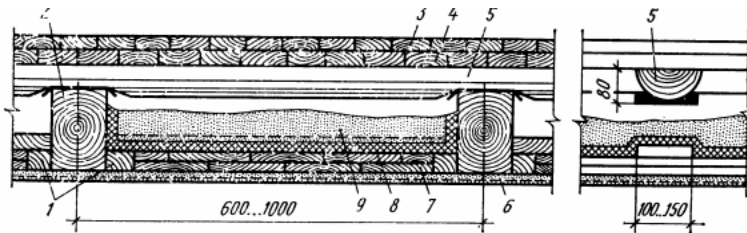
Конструкція дерев'яного междуэтажного перекриття:
